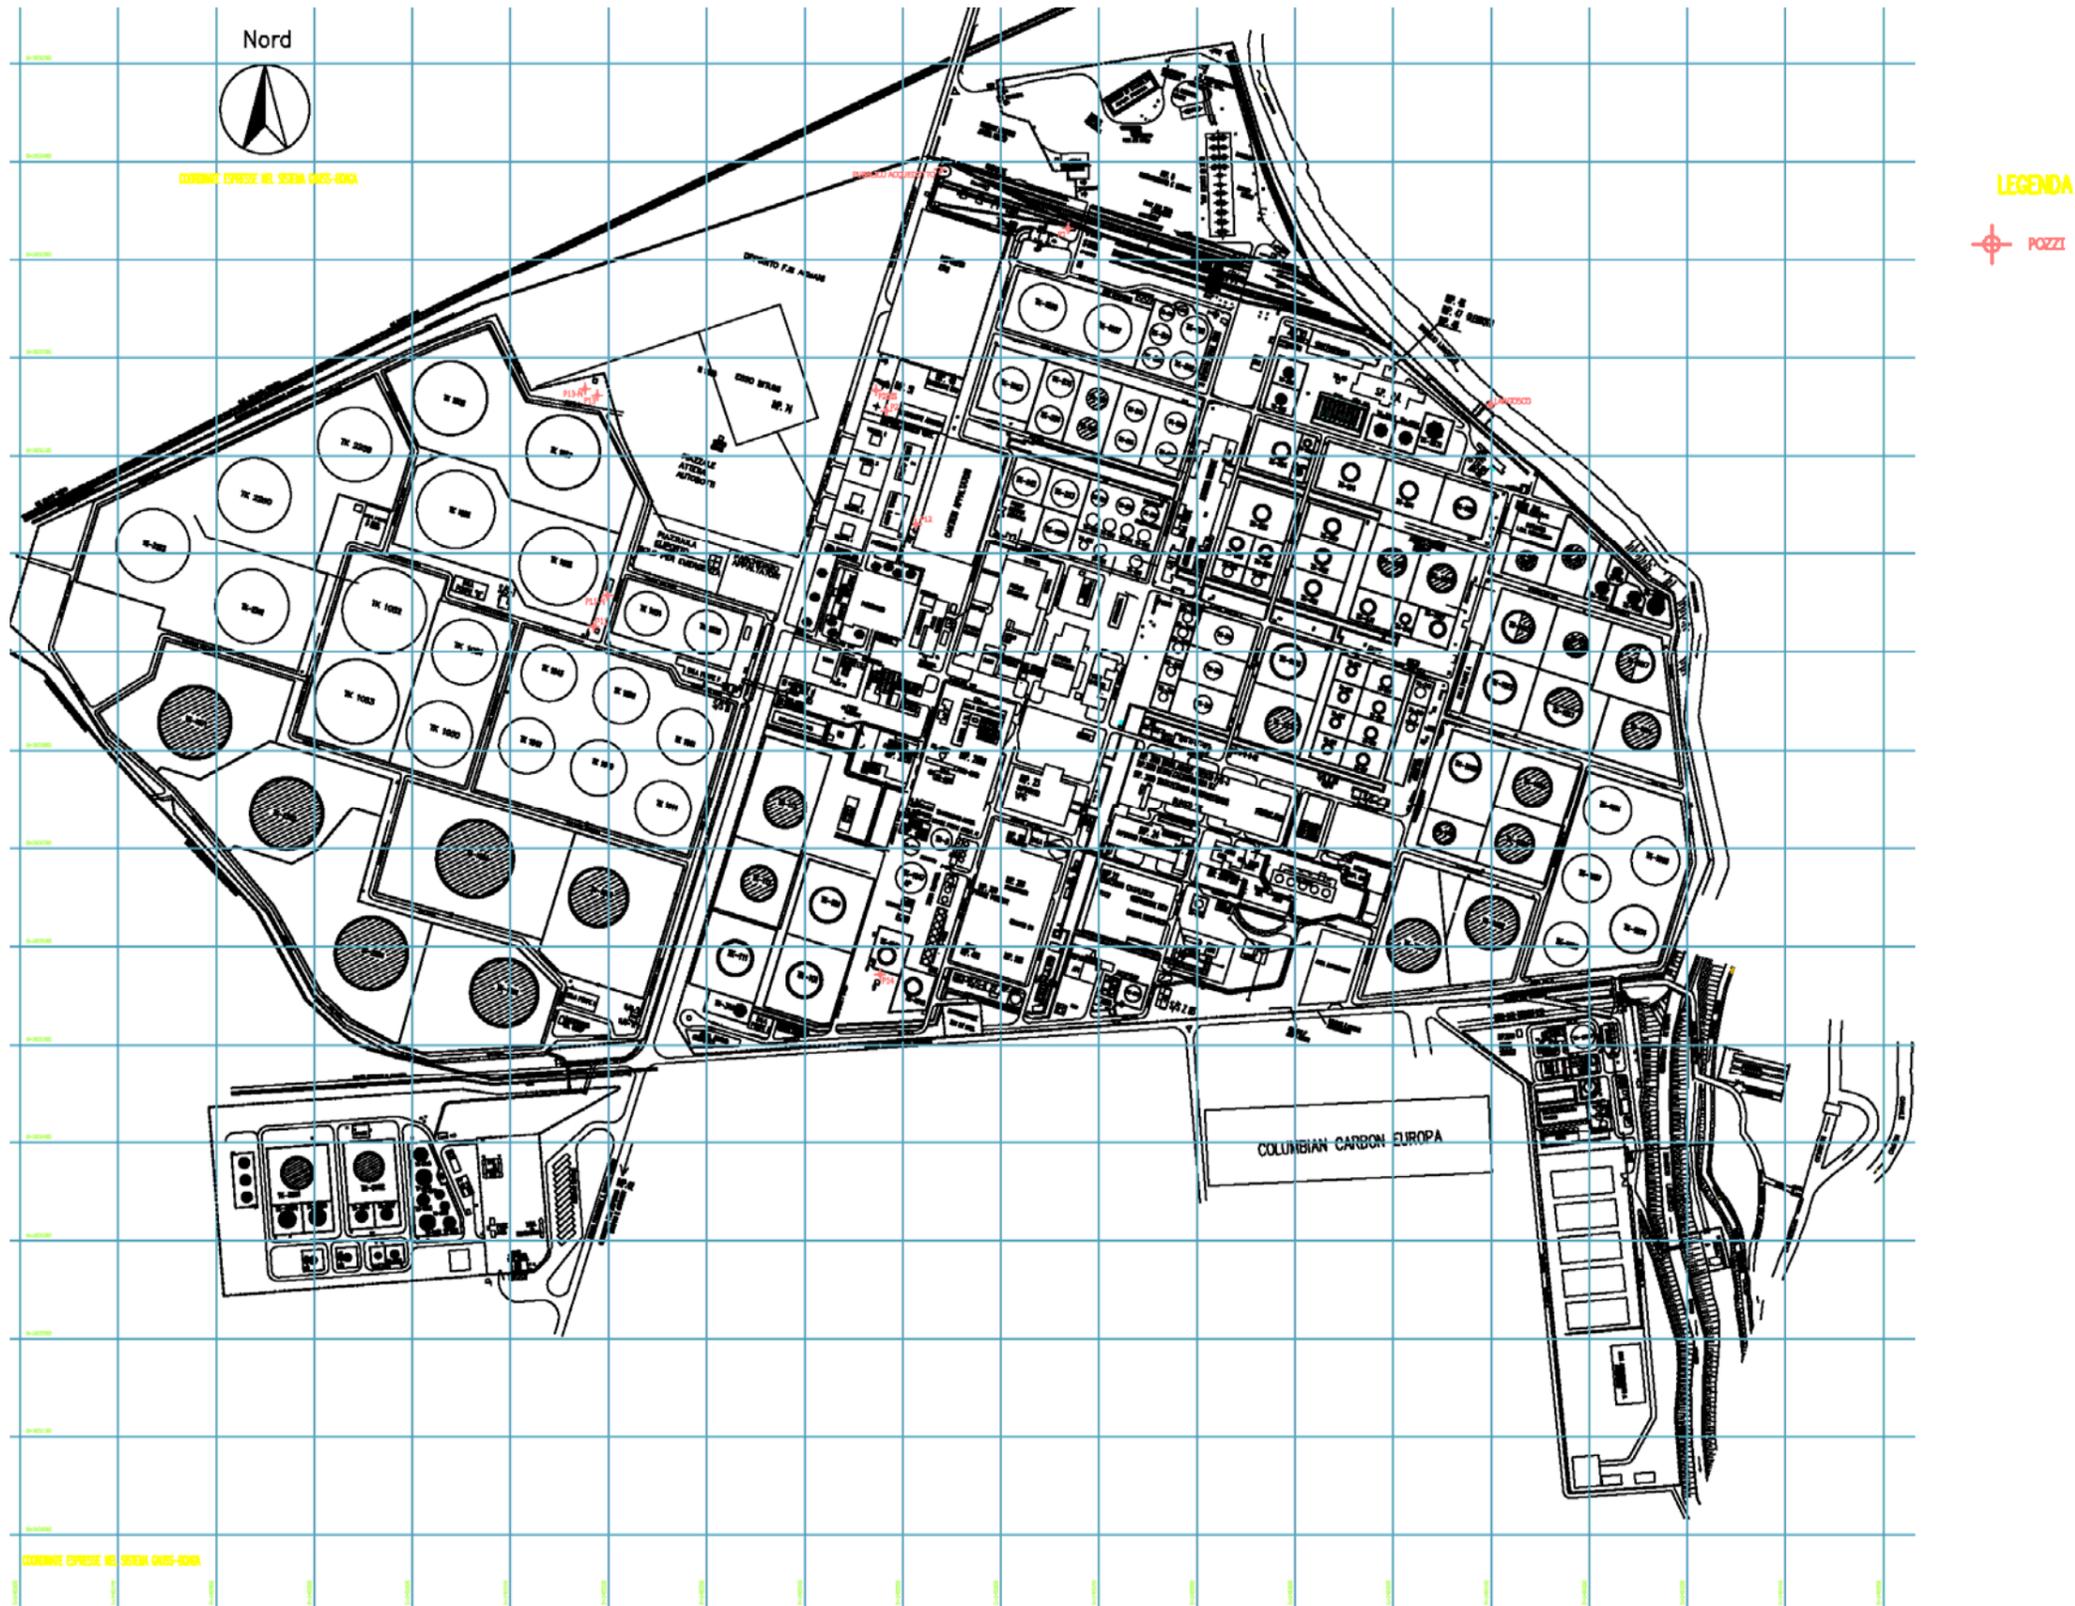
Planimetria con ubicazione dei punti di approvvigionamento idrico
